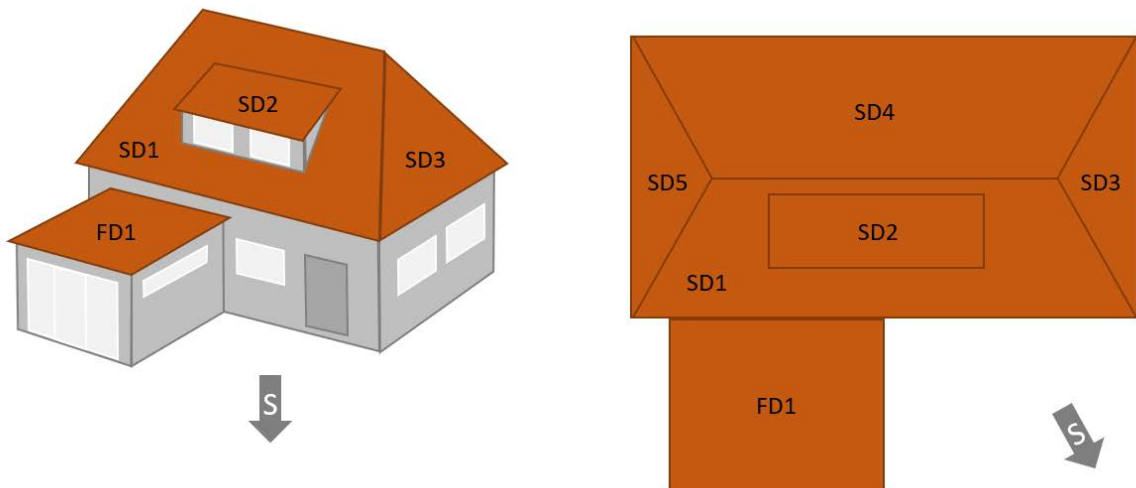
Südansicht eines Gebäudes mit Walmdach und Flachdachanbau (links), Dachplan des Gebäudes mit solargeeigneten Dachflächen FD1 (Flachdach), SD1, SD2 und SD3 (südlich ausgerichtete Steildächer) sowie nicht solar geeignete Steildächer SD4 und SD5 (da nördlich ausgerichtet)
